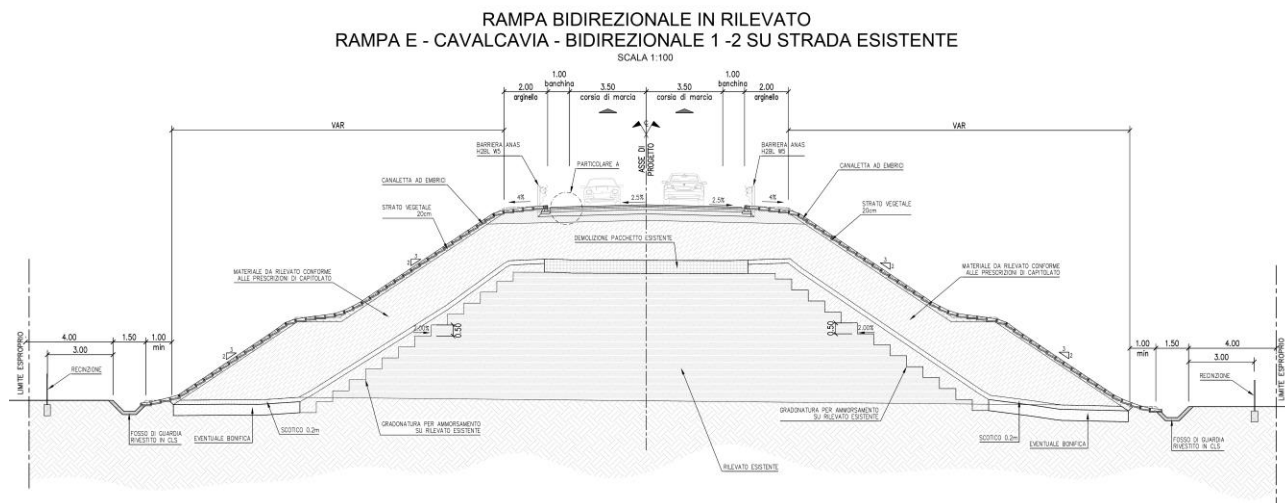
Sezione tipo rampa Bidirezionale con ammorsamento su rilevato esistente
